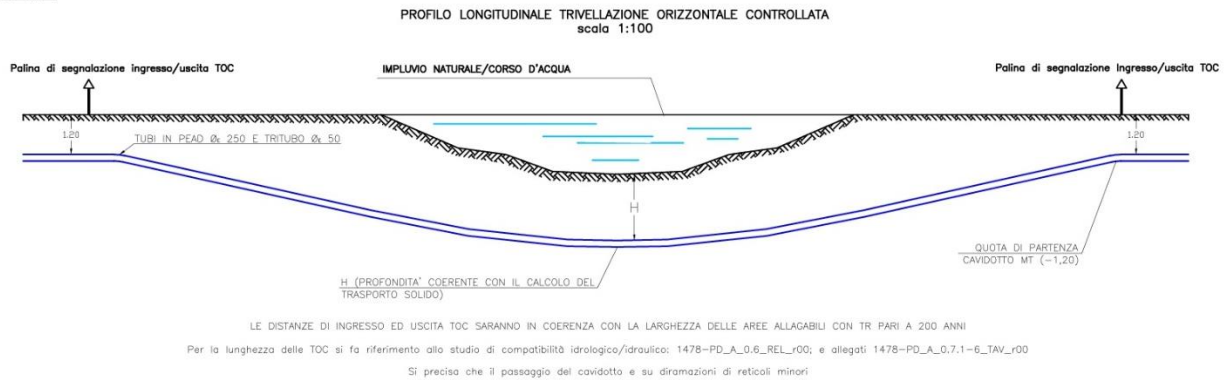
planimetria e sezione di un attraversamento in sub-alveo.
